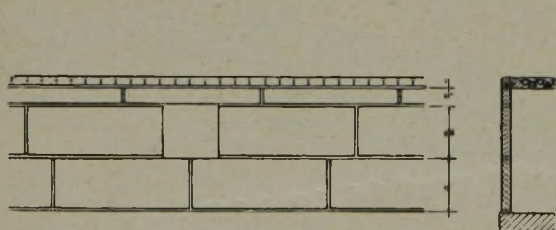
Schichtplan für 1. Geschoß. 1 = Brüstungsschicht
